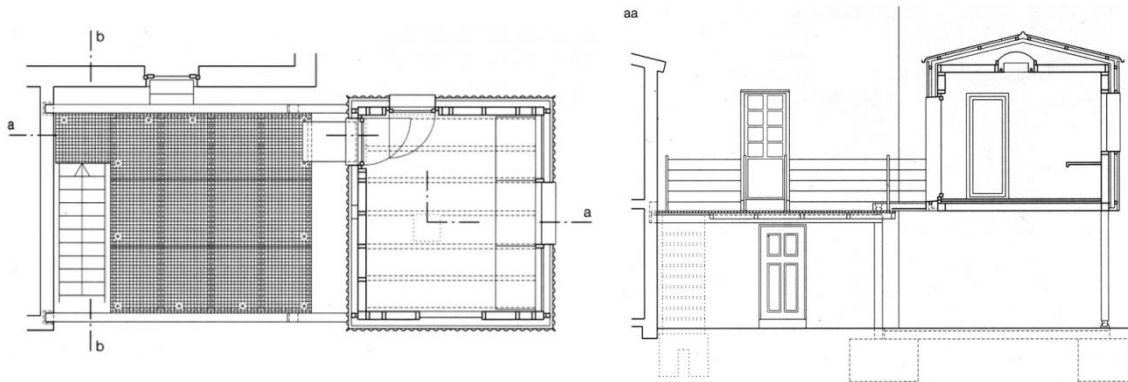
Fahrt ins Grüne*, planta e secção.
